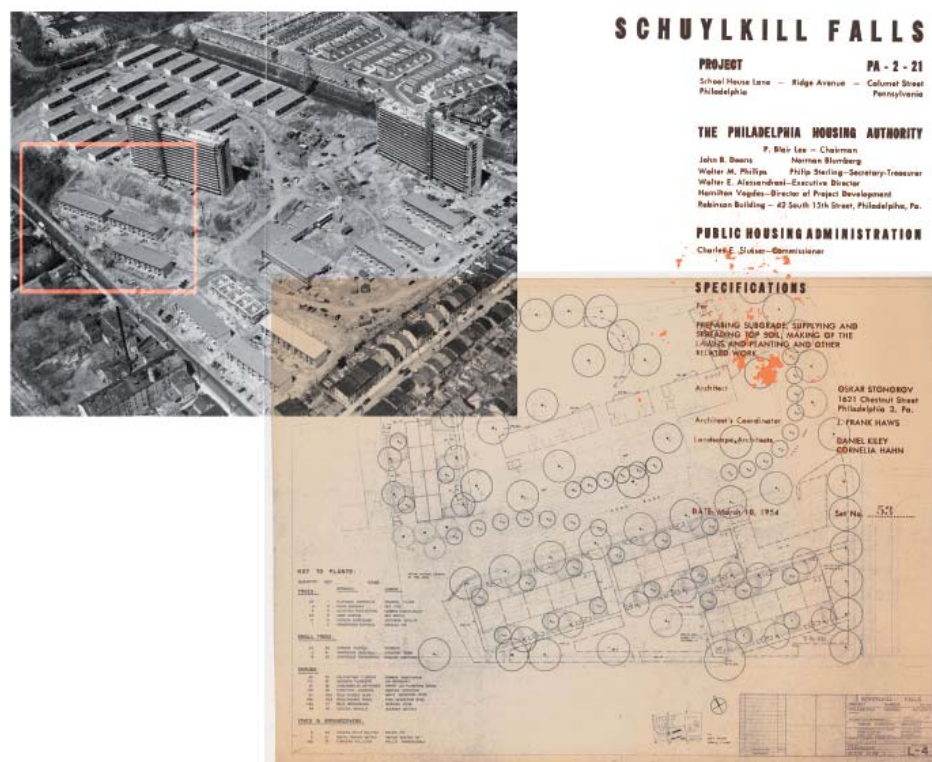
Vista aérea ‘Schuylkill falls’, 1954. - Plano Detalle Paisaje Bloque D
